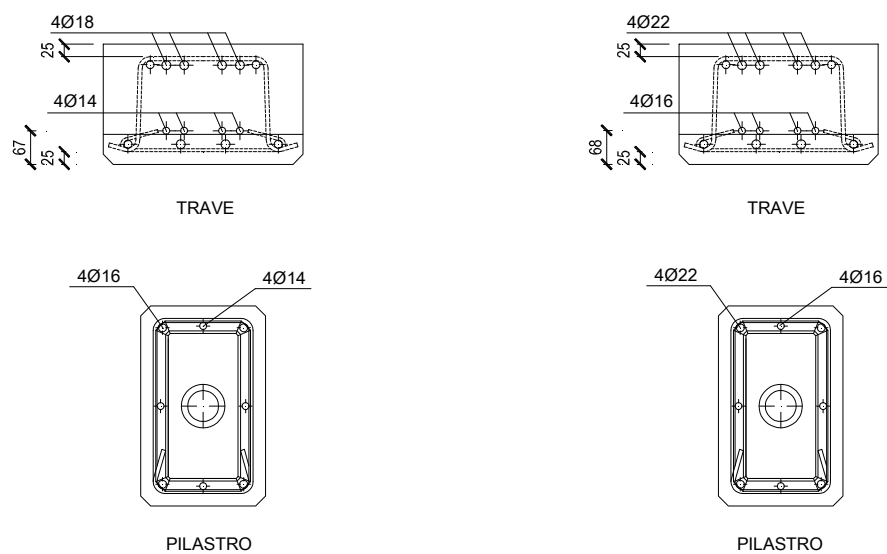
Schema campione prefabbricato della serie TST con pilastro in asse debole
